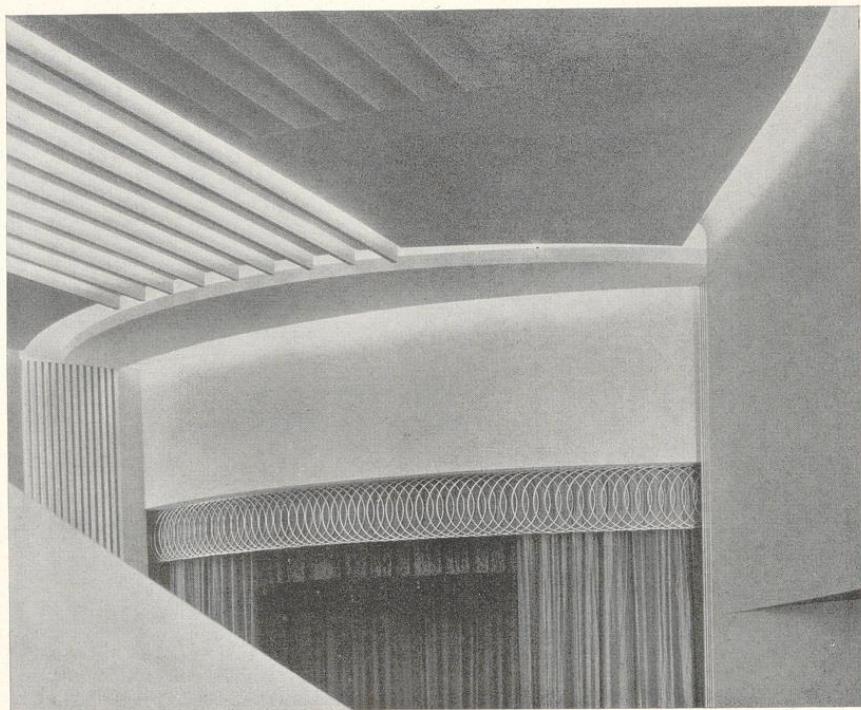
Rabitzdecke mit Beleuchtungsrinnen im früheren Universum-Lichtspielhaus in Stuttgart. Architekten Schmohl und Staehelin, Stuttgart. Ausführung K. Mühleisen, Stuttgart
